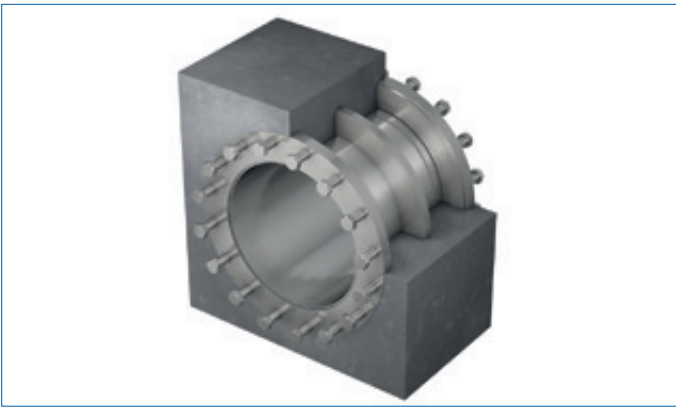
Wanddurchführung mit wandbündigem Mauerflansch
